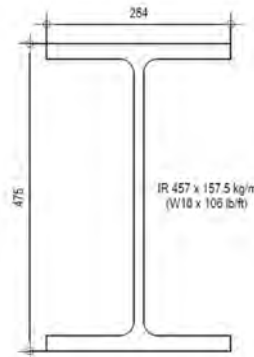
Sección transversal de vigas principales. Fuente: Elaboración propia.
